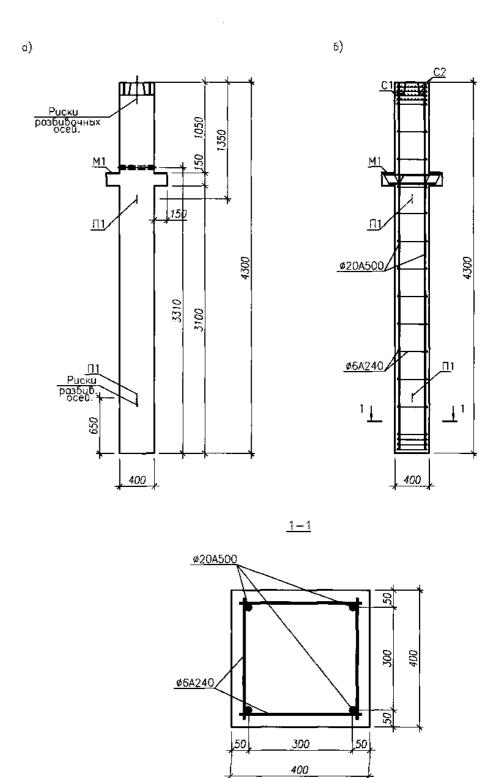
К расчету колонны а — опалубка колонны ; б — схема армирования
